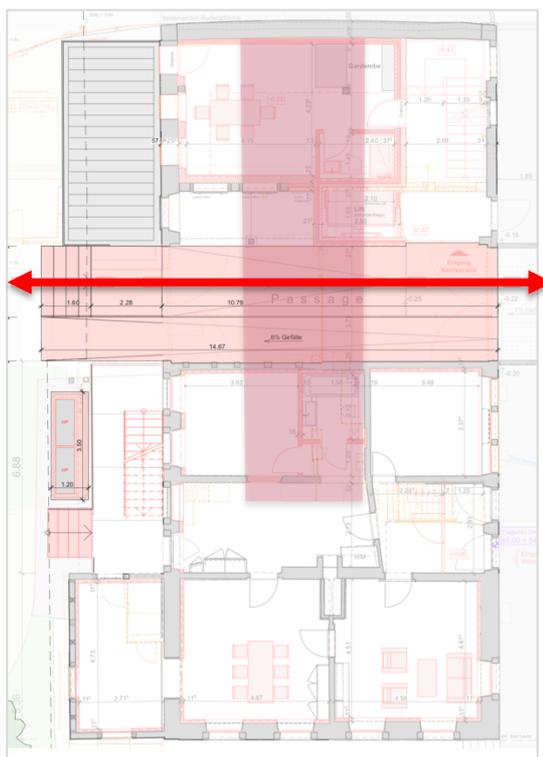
Ansicht EG Bauernhaus mit Passage (rot eingefärbt)
